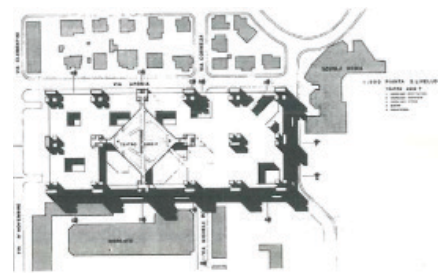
Planimetria del Condensatore Castelfidardo.
